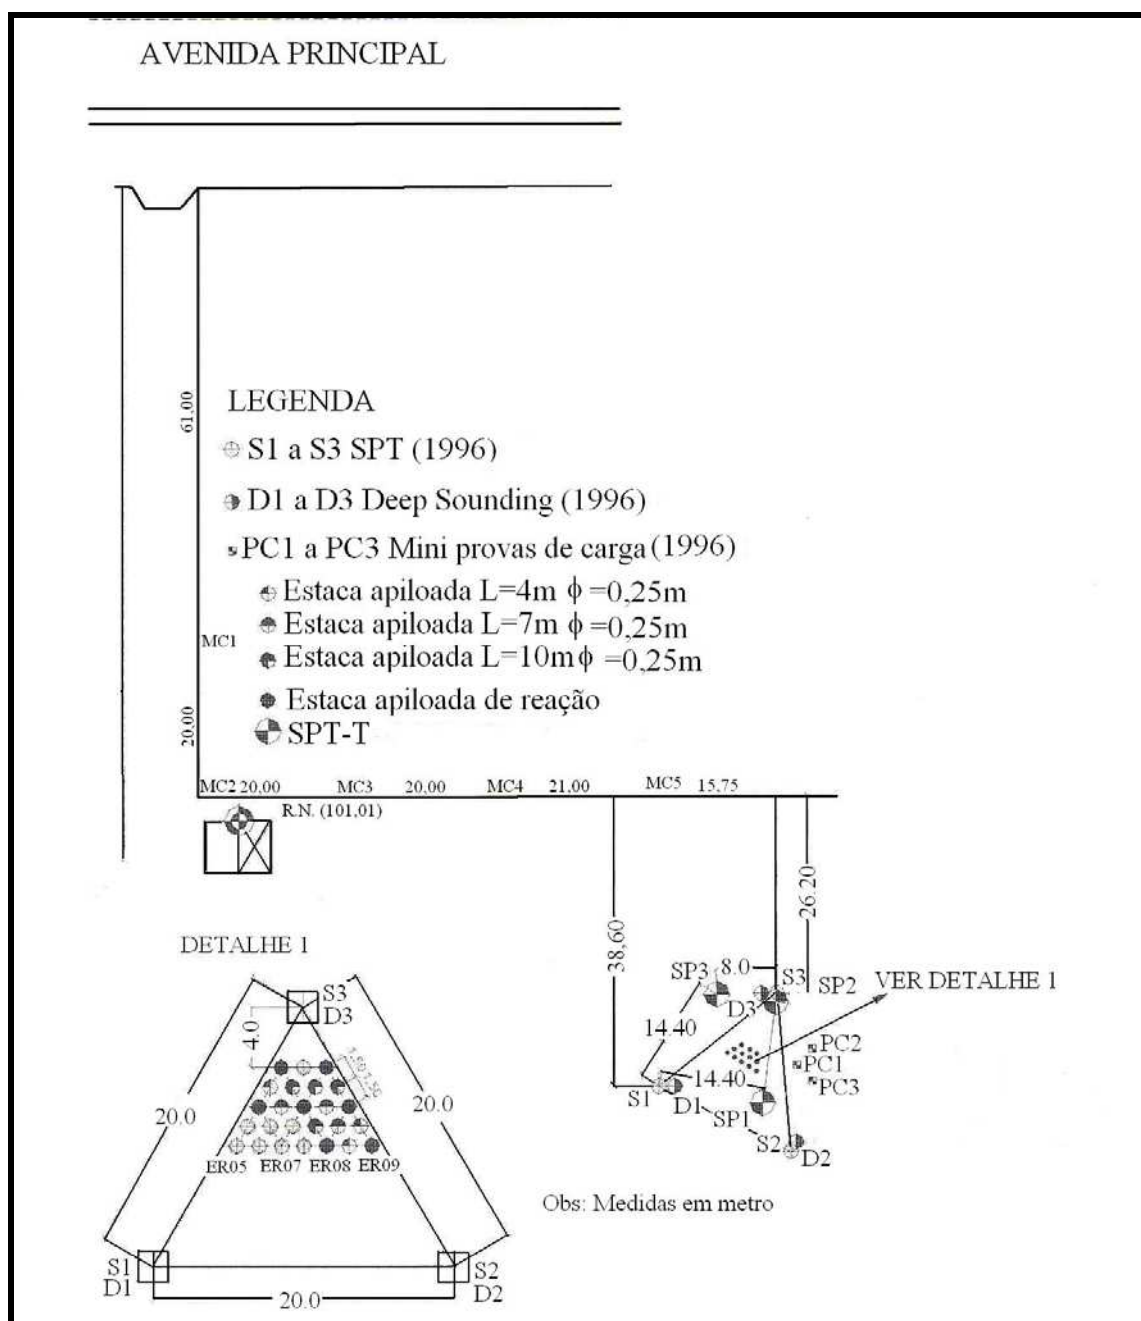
Planta do Campo Experimental Unesp Bauru (Apud Peixoto 2001).
